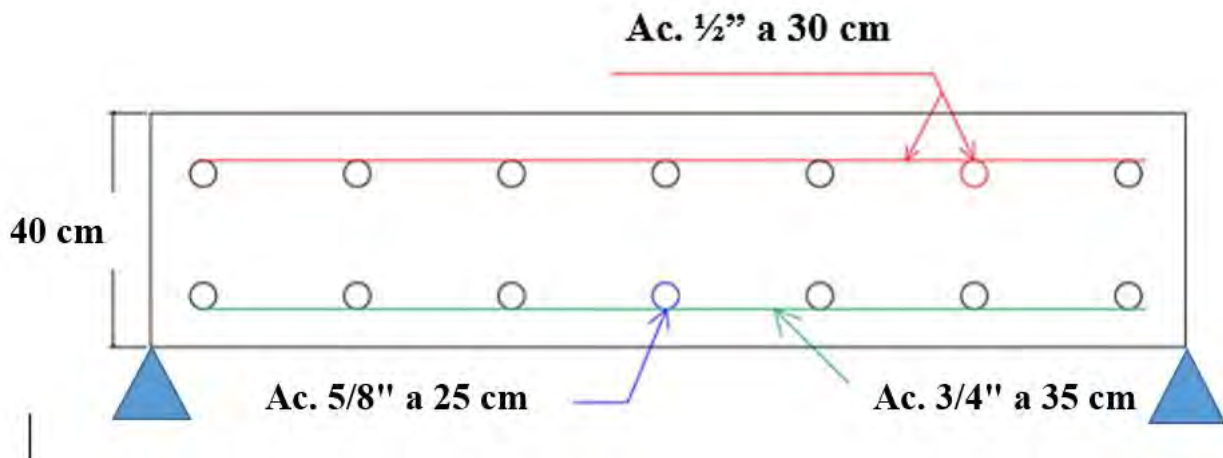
Distribución de acero de la losa. Fuente: elaboración propia.
